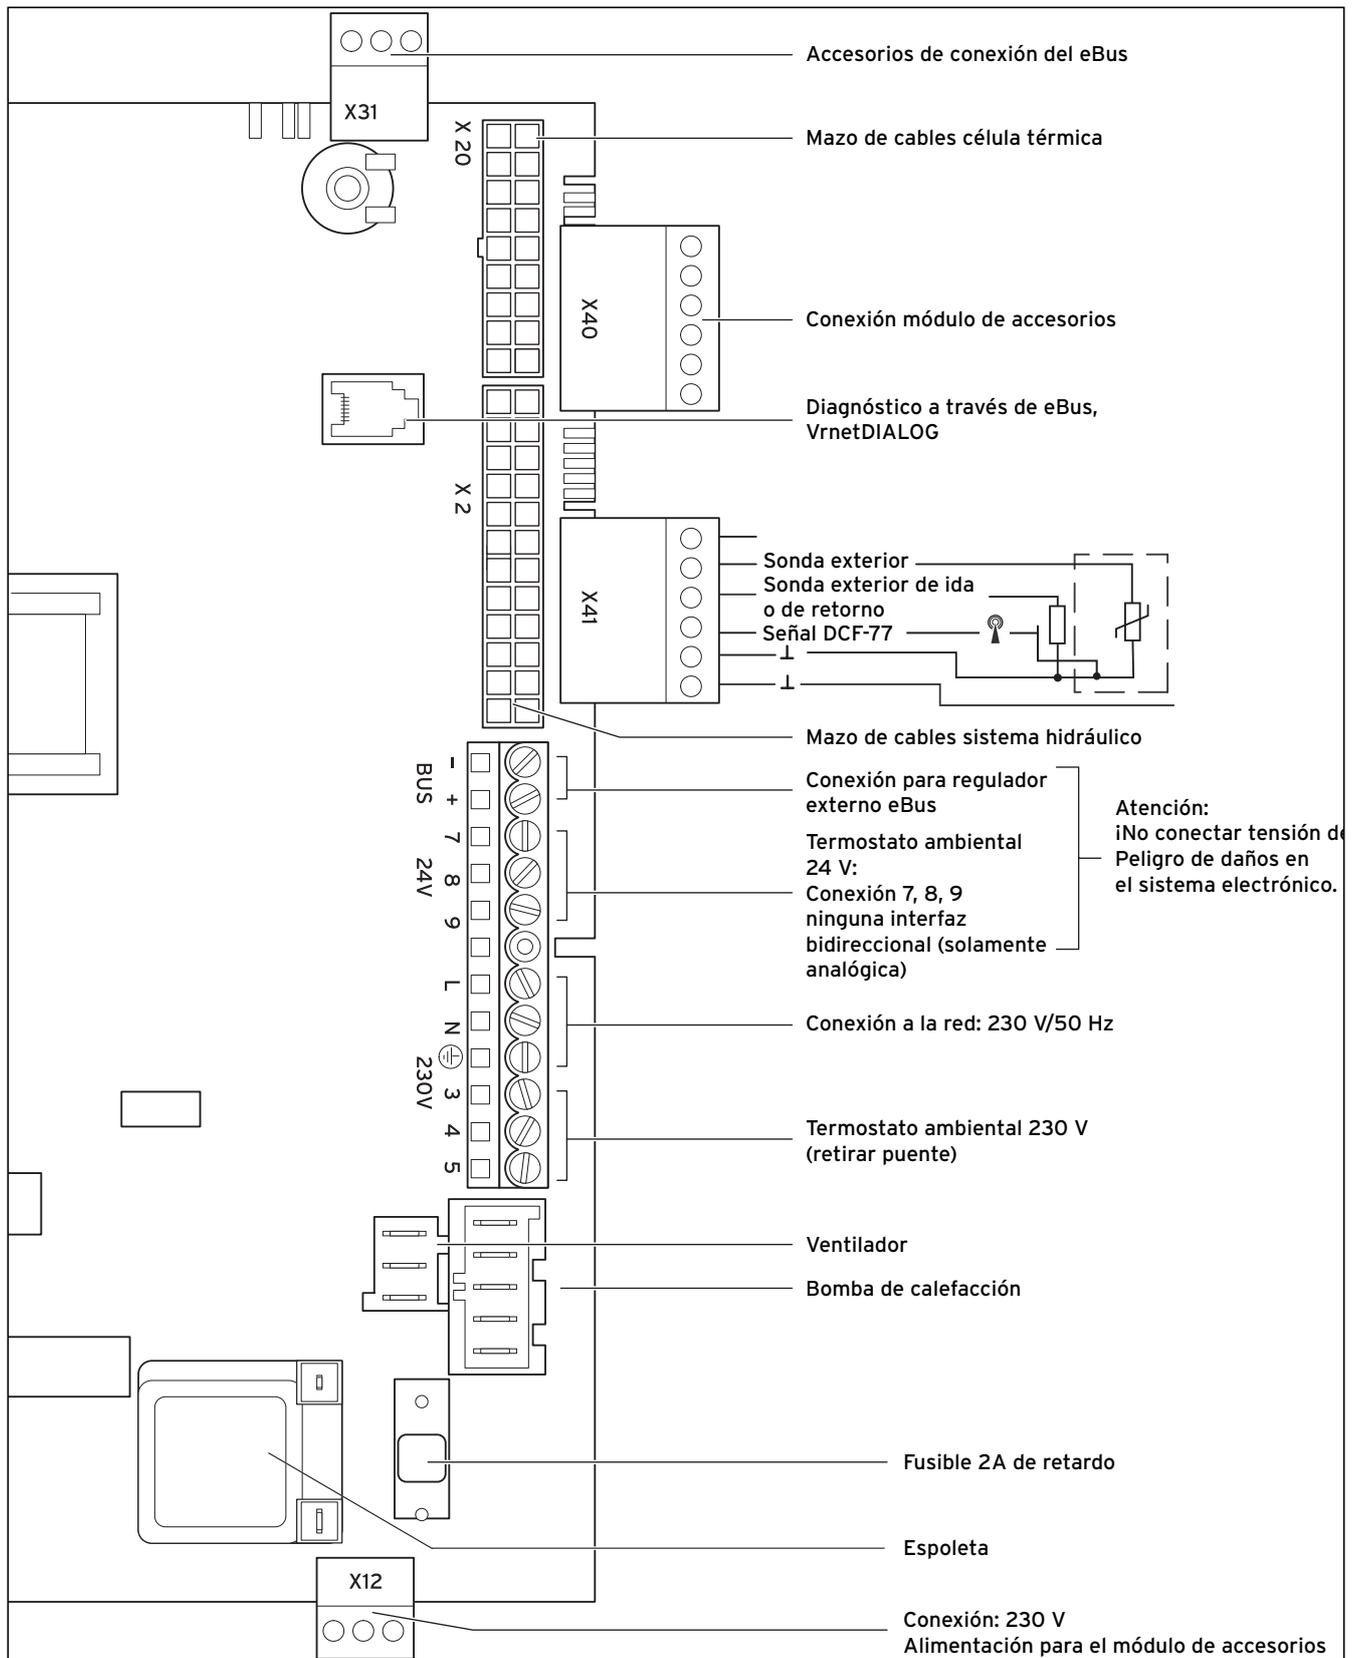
Plan de conexiones turboTEC plus/turboTEC pro
